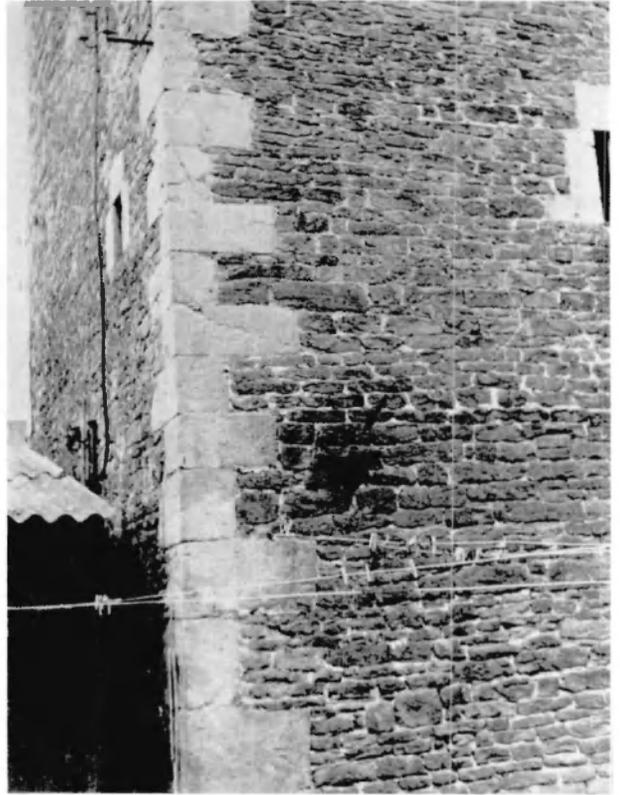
Tamines. Débouché du conduit d'évacuation d'eau à l'est.
